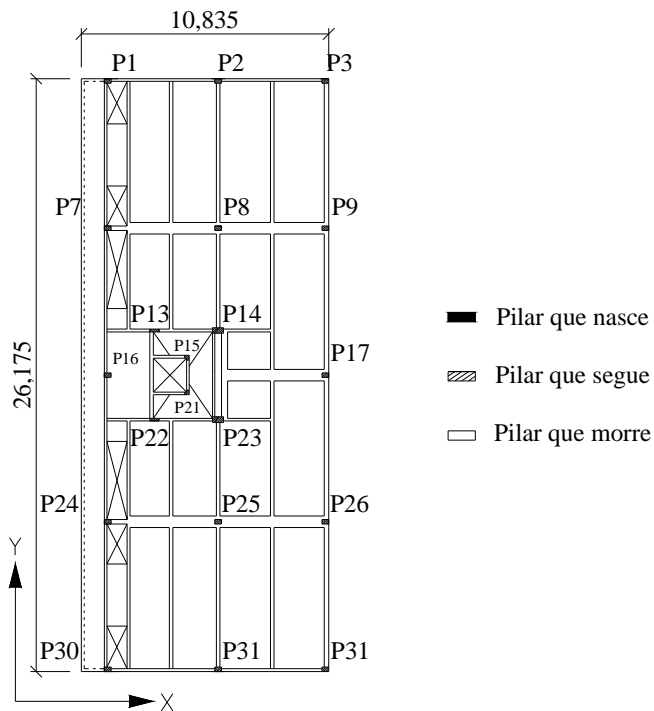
Estrutura do 2º pavimento (dimensões em metros).
